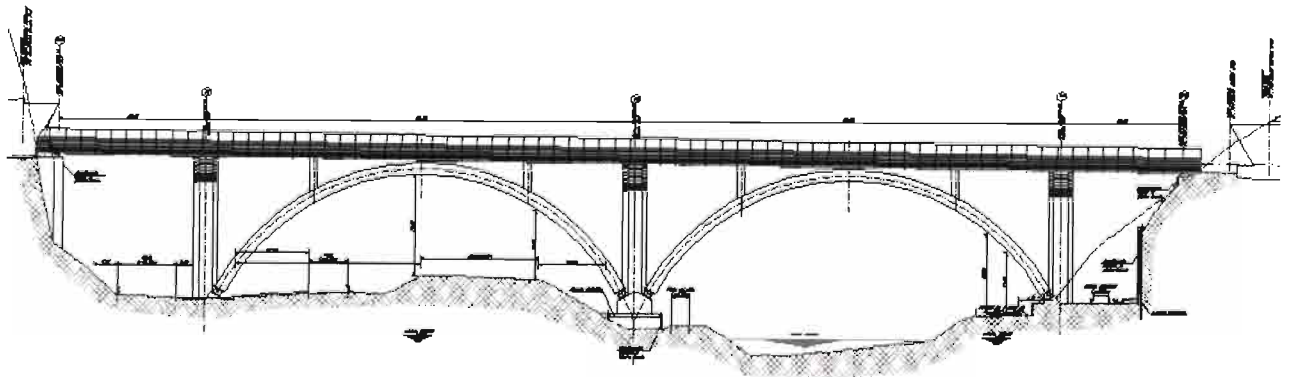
Ponte Fiume Isarco: Prospetto Viadotto Binario Pari
